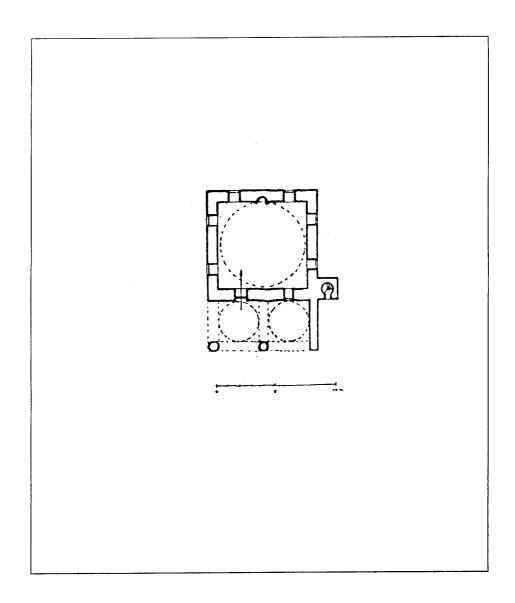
مكرر) مسقط أفقي لمسجد علي باشا في Szigetvar المجرية (عن : جيرو) .
